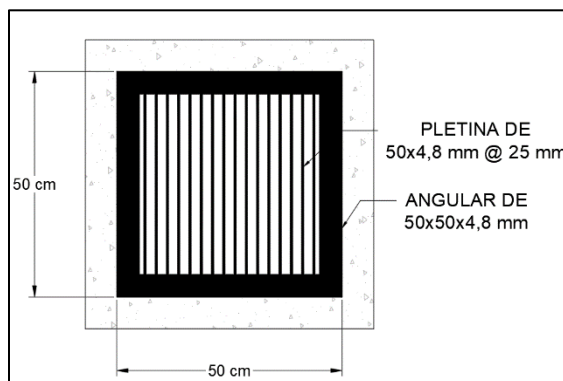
Detalle de rejilla metálica para cajas de registro pluviales.
